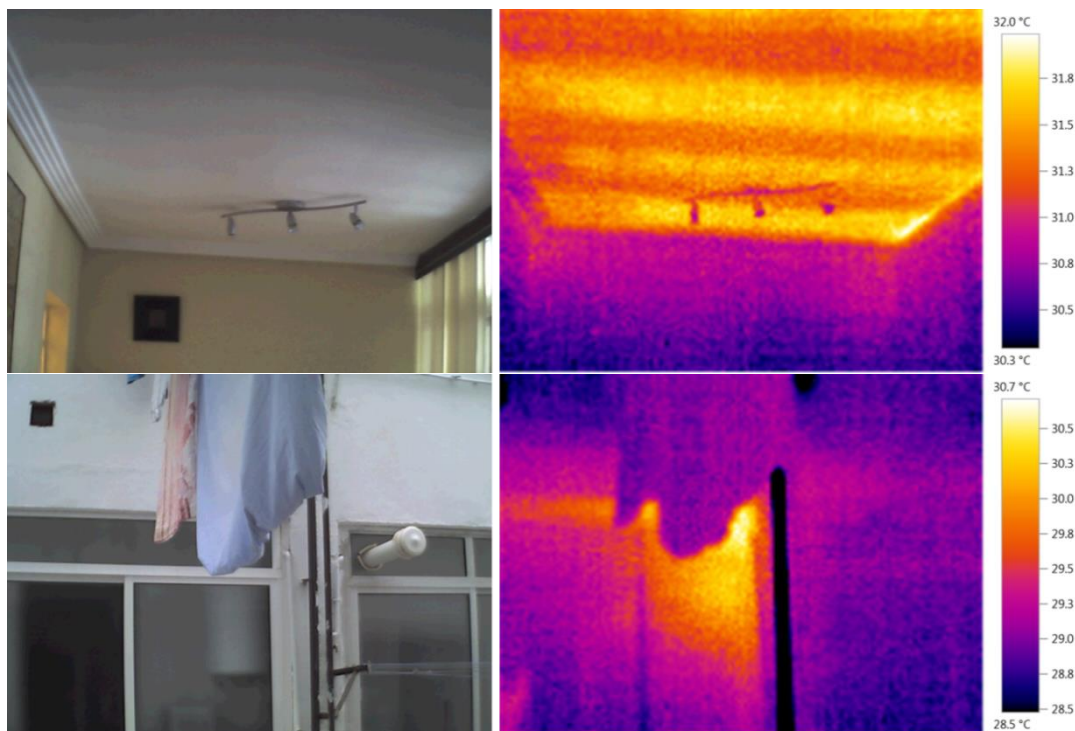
Imágenes termográficas del interior de una vivienda de última planta con orientación Este arriba y de un acumulador eléctrico para ACS mal aislado abajo. Fuente: elaboración propia para Proyecto Barrios en Transición, 2015.
